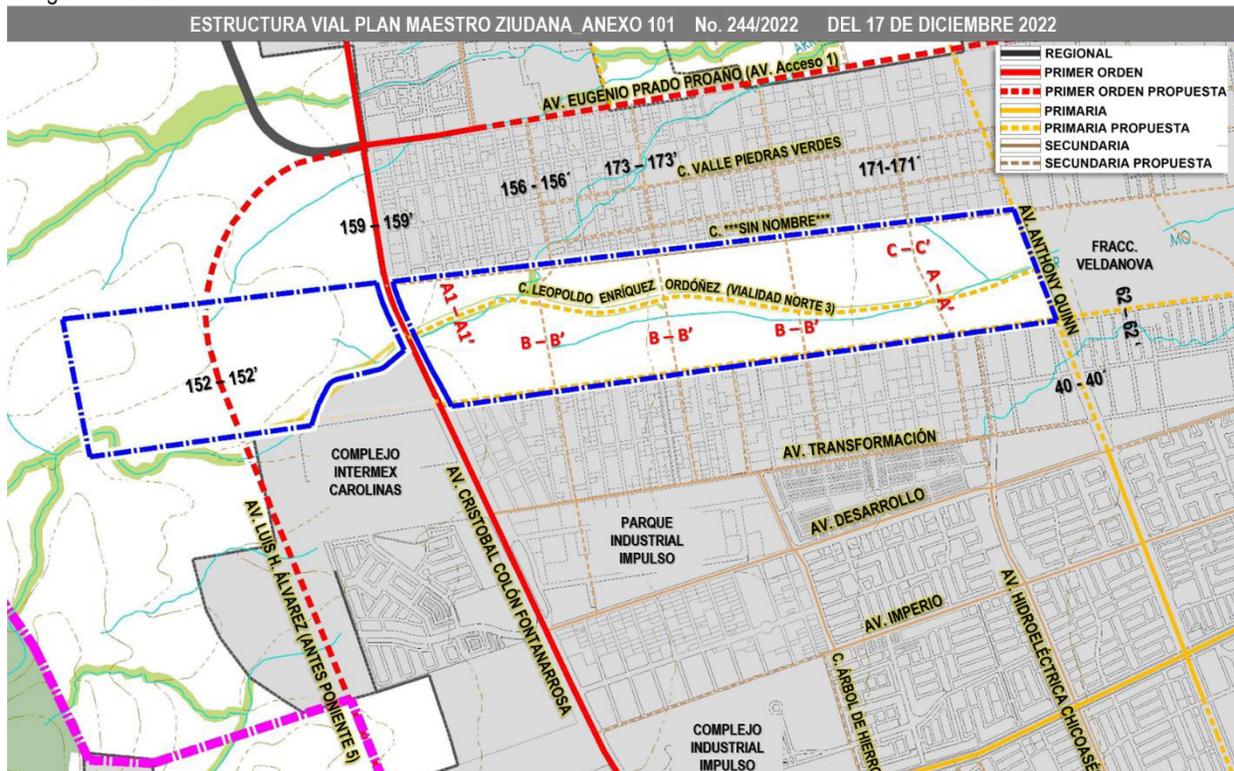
Secciones viales propuestas dentro del Plan Maestro de Urbanización “Ziidana”.
